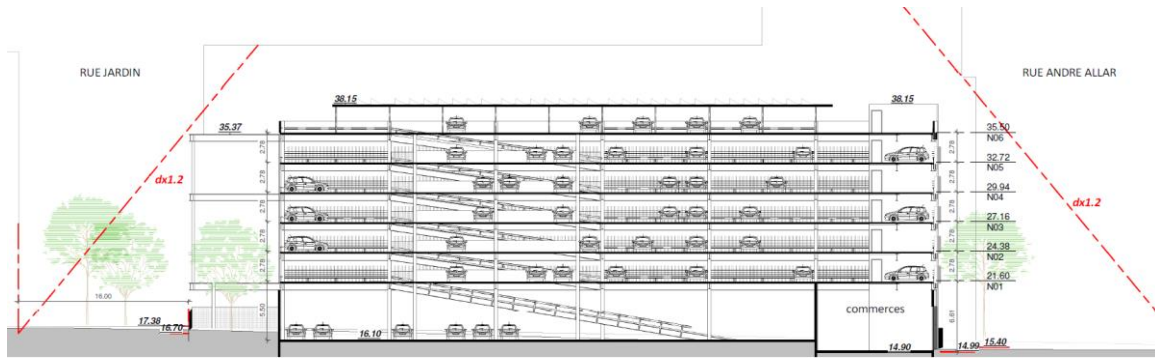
Coupe de la façade Ouest avec les dimensions de l'îlot 4C1 (parking)
